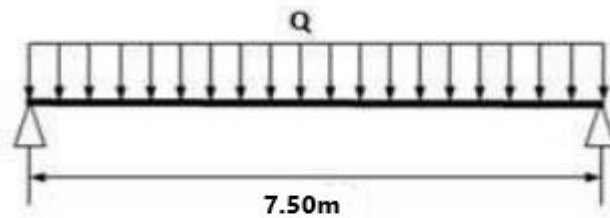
Schéma statique de la poutre de roulement sur deux appuis.
